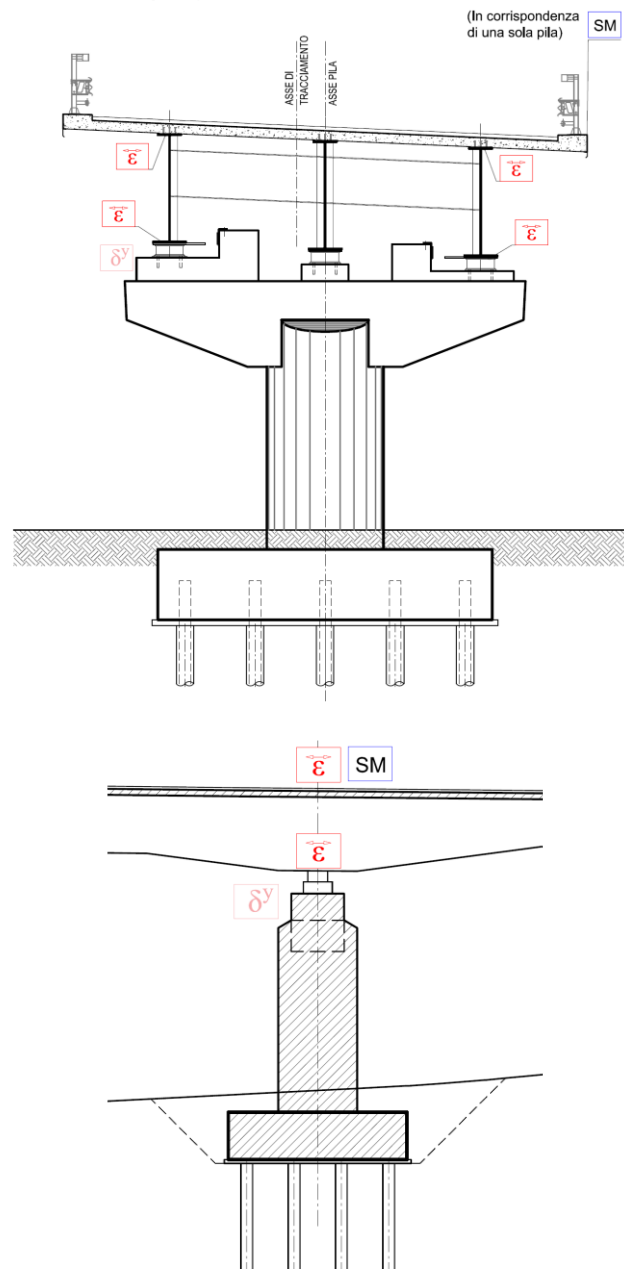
Ubicazione sensori su pile (sezioni trasversale e longitudinale ponte S. Antonio)
